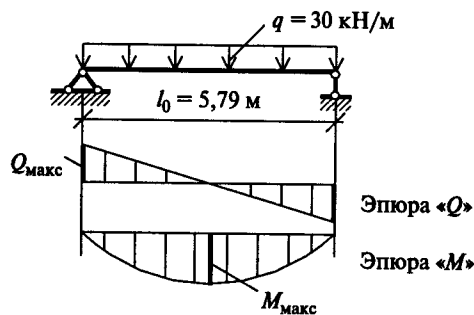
Расчетная схема балки — к примеру 7.10
